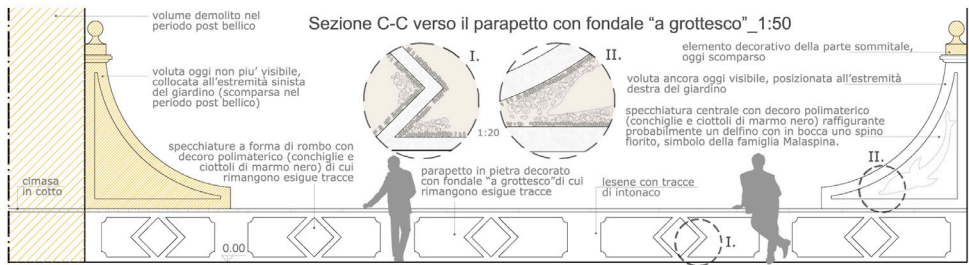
Sezione del giardino verso il parapetto con fondale decorato “a grottesco”. Estratto dalle tavole di Tesi (tav. 7)
